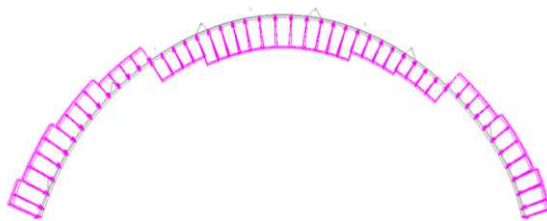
Загружение в ПК SCAD на фрагмент покрытия от ветровой нагрузки (X+)
